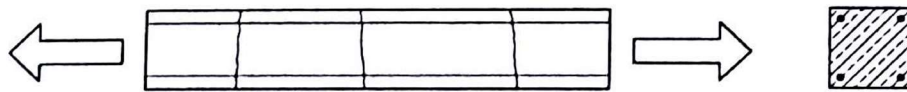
Exemplo de fissura causa por esforço de tração (Cóias, 2009).
